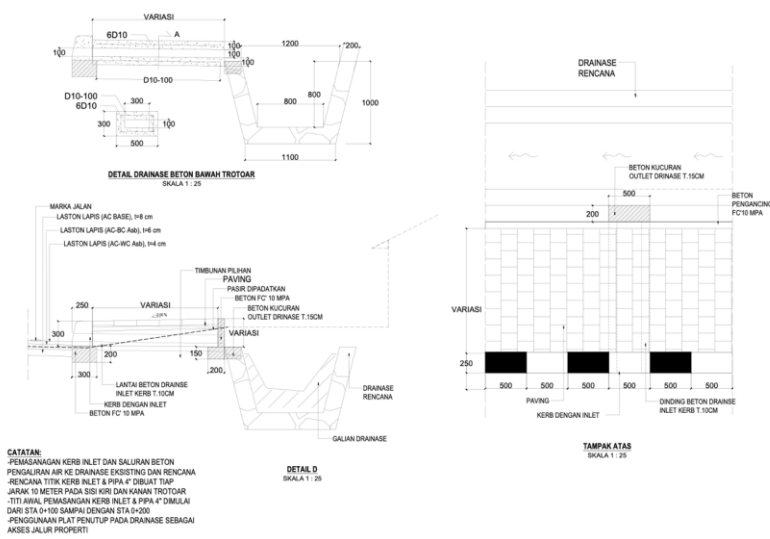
Tipikal potongan melintang penanganan badan jalan, drainase, dan trotoar
